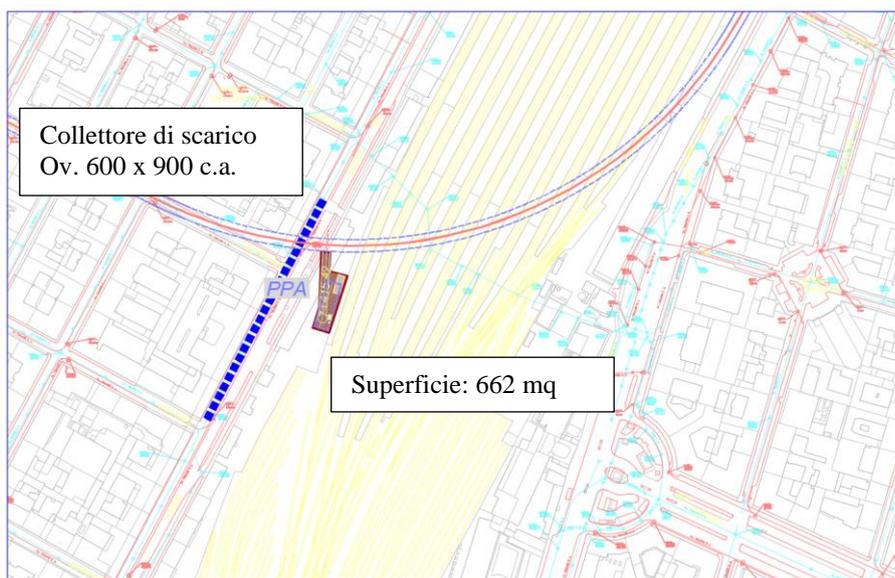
Aree di cantiere – Pozzo PPA – FASE UNICA
